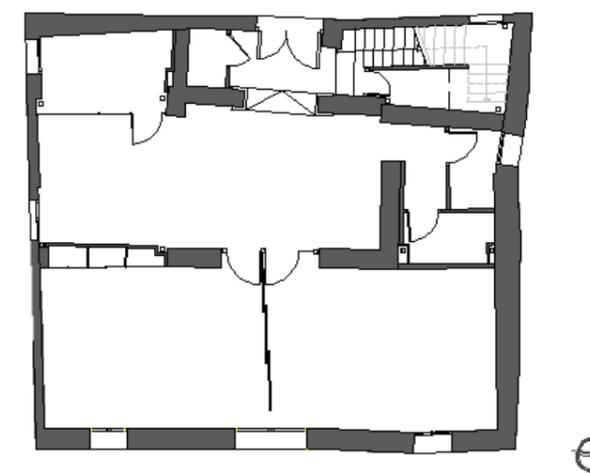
Planta actual de la alquería Benlloch. Fuente propia
